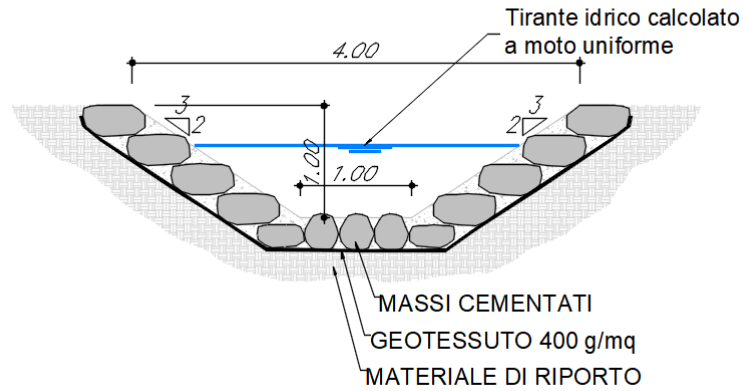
Corso d'acqua IN18_Sezione tipo sistemazione
